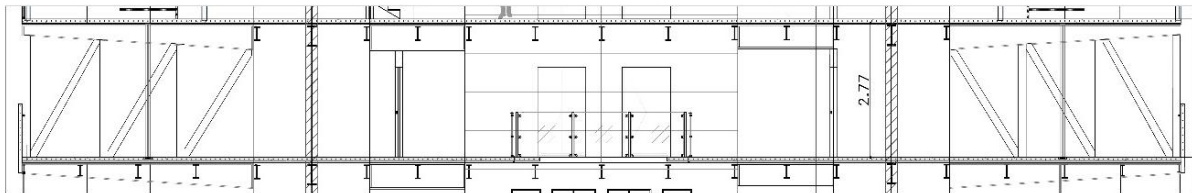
Detalle de losa – remate con muro periférico y anclaje a la caja de gradas
